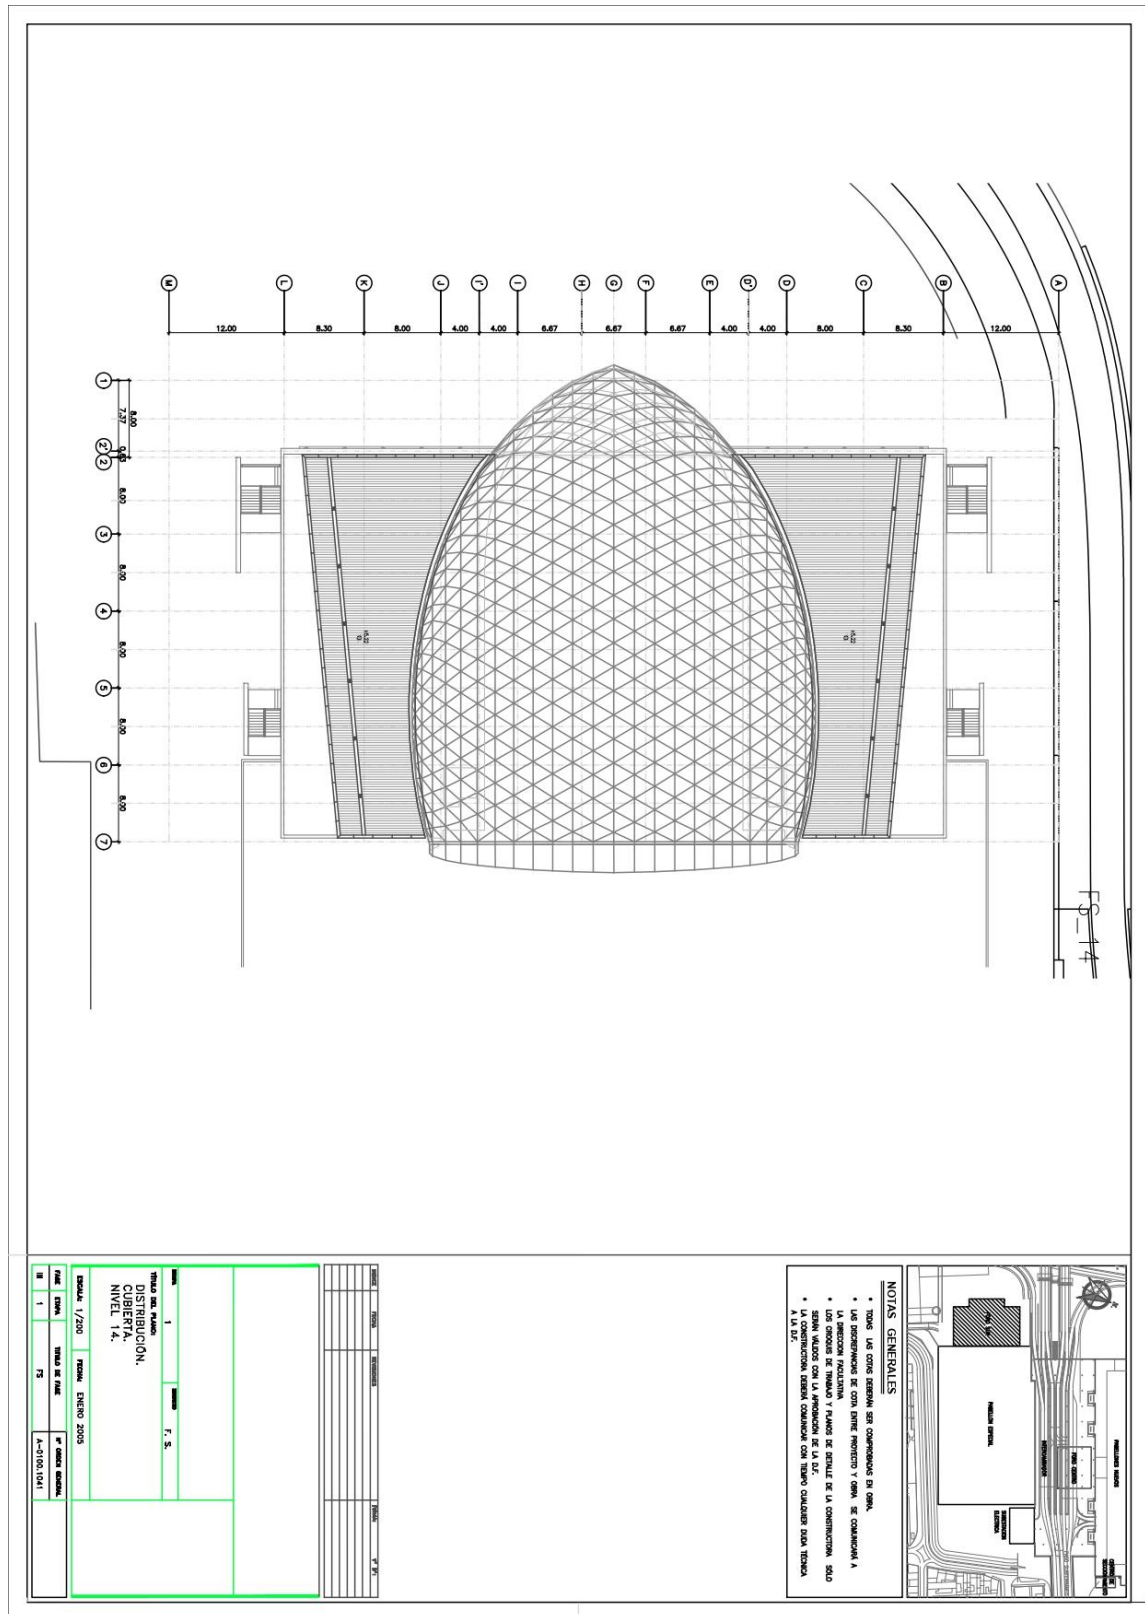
Planta de cubiertas del Centro de Eventos.
